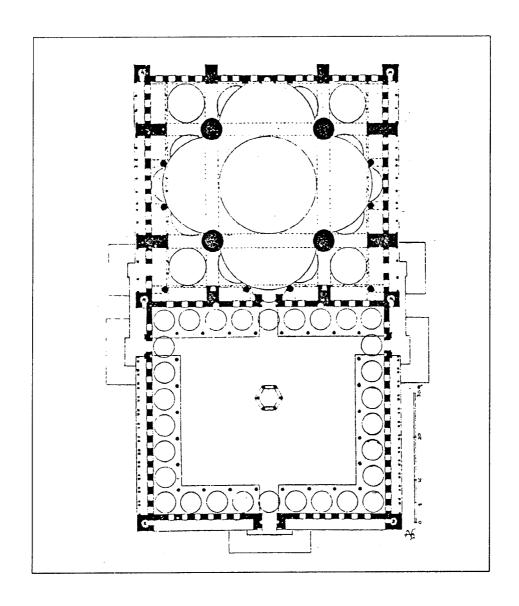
مسقط أفقي لمجمع السلطان بايزيد في إستانبول (عن : جابرييل) .
